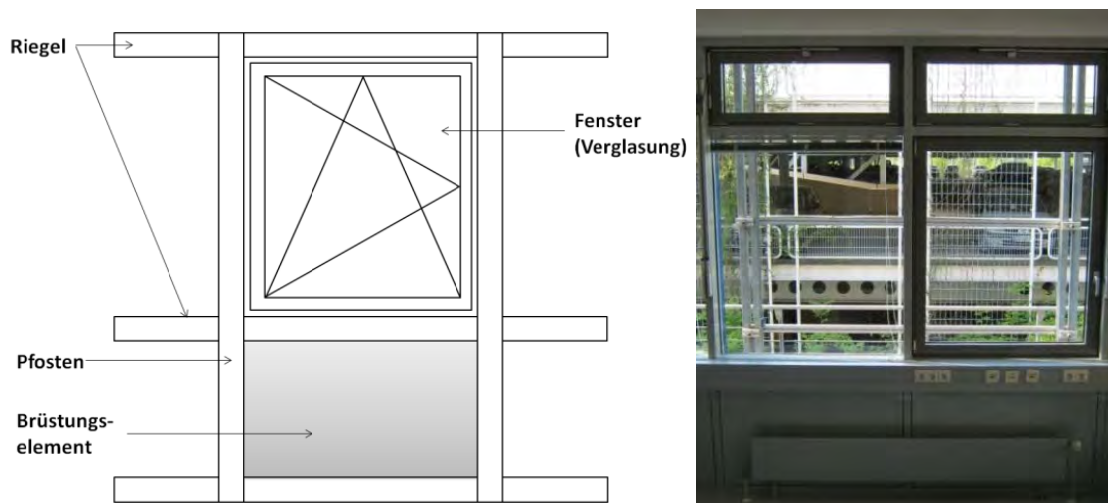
Schema eines Elements einer Pfosten-Riegel-Fassade (links) und Foto Testfassade (rechts).
